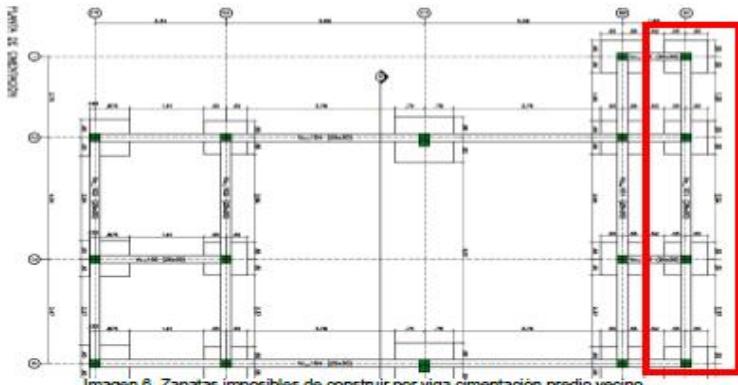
Zapatas imposibles de construir por viga cimentación predio vecino.
